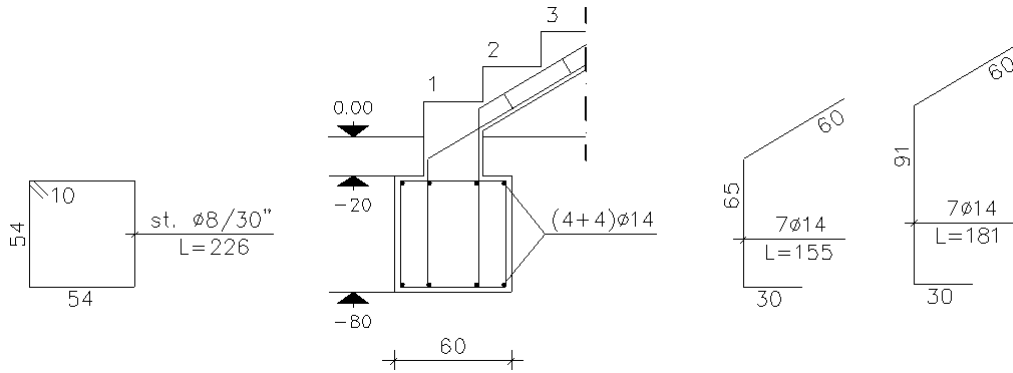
Ex-Lavanderie - stato di progetto: trave di fondazione scala (Sez. C-C)
